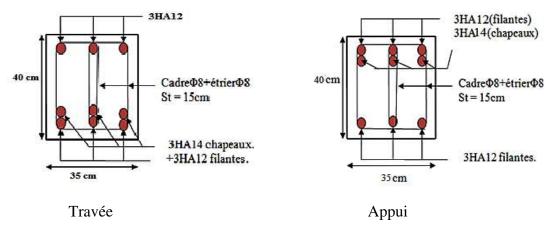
Schéma de ferraillage des poutres principales de RDC - 7 étages.
